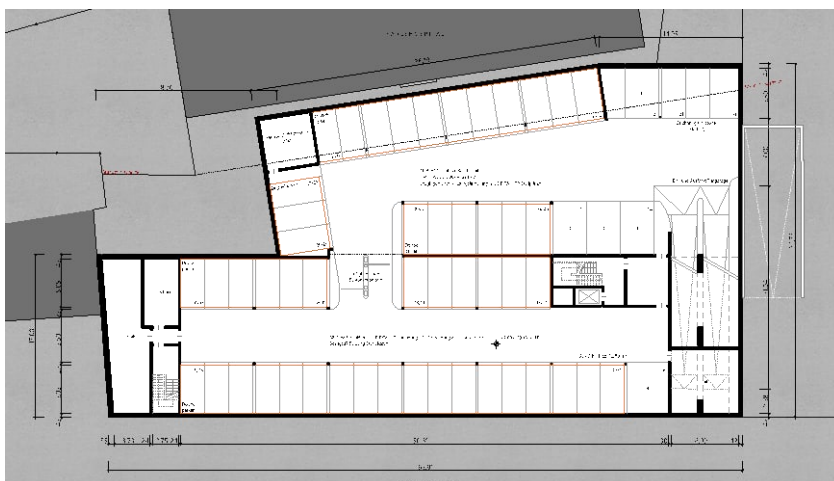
Vorhaben- und Erschließungsplan - Grundrissplan Tiefgarage – Stand: Offenlage August 2023
